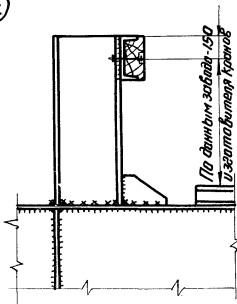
Крепление железнодорожного рельса к подкрановой балке на кранах.
